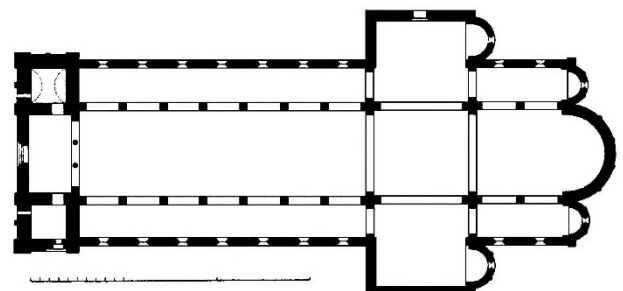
Grundriss der Klosterkirche Breitenau
